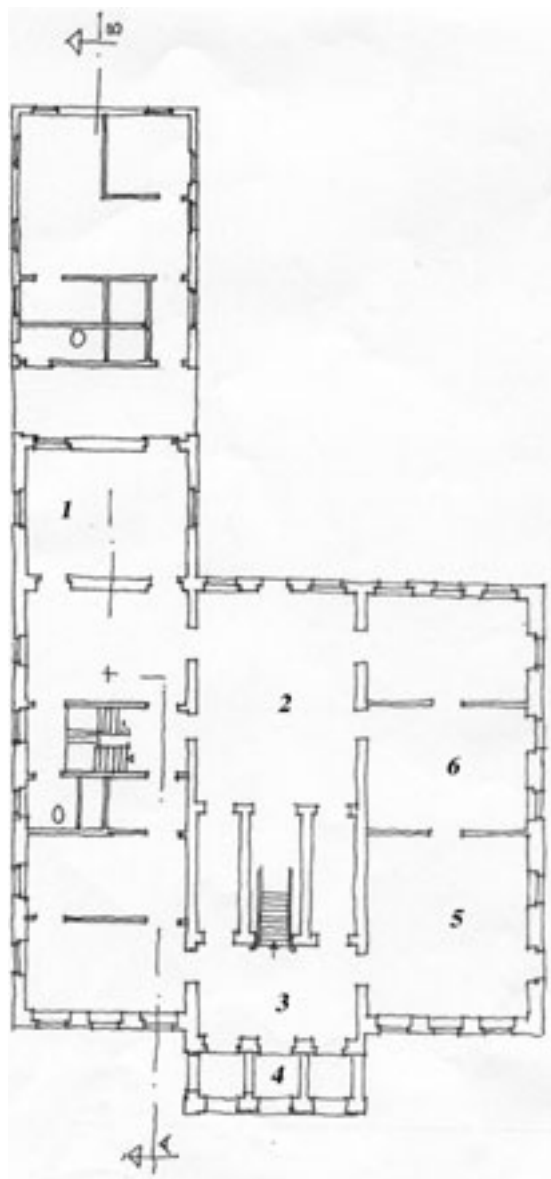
SOLAR RODRIGUES MENDES, RECIFE – PE, PLANTA-BAIXA DO PAVIMENTO TÉRREO.
